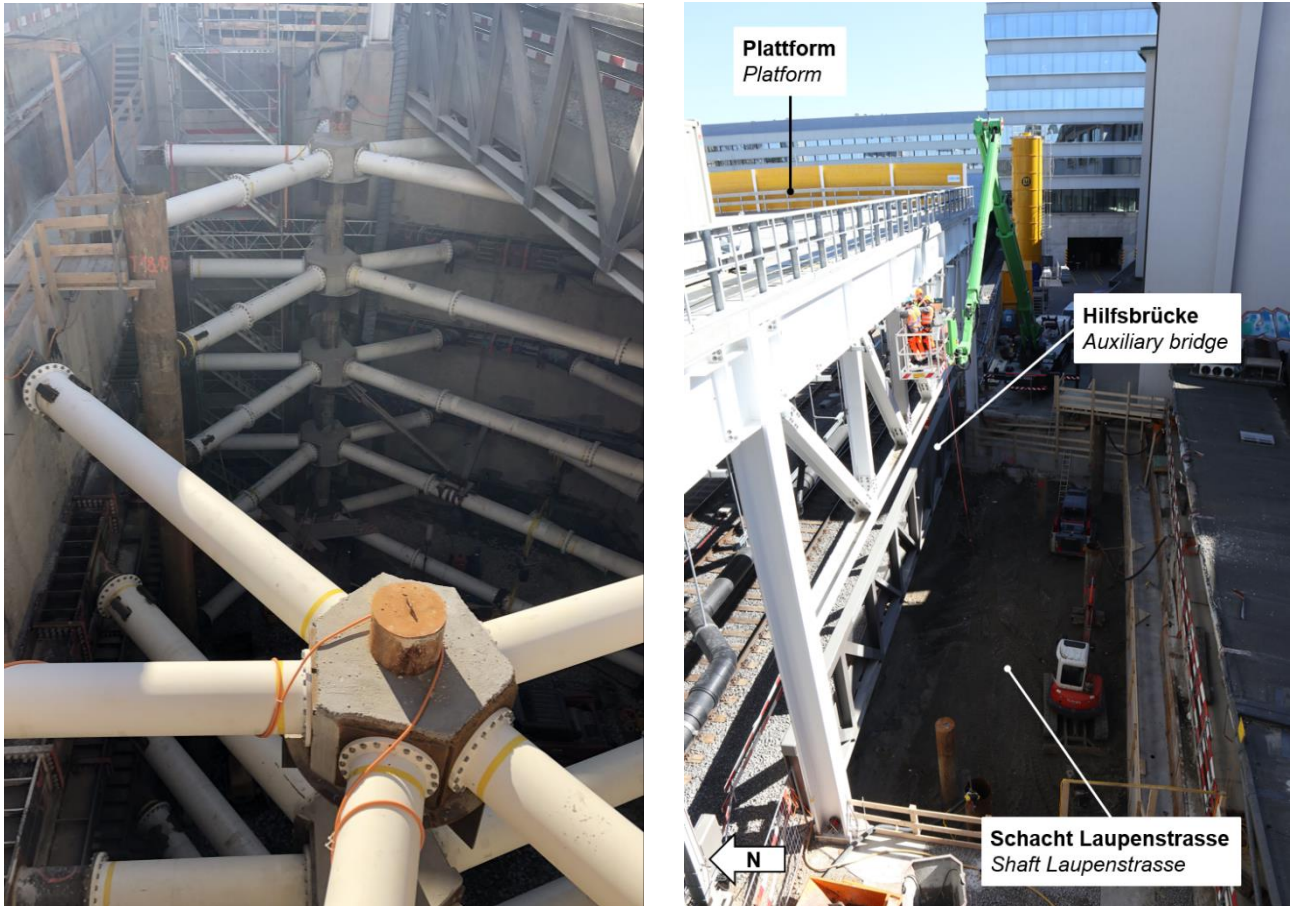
Schacht Laupenstrasse – links: Blickrichtung West; rechts: Blickrichtung Ost [9]
